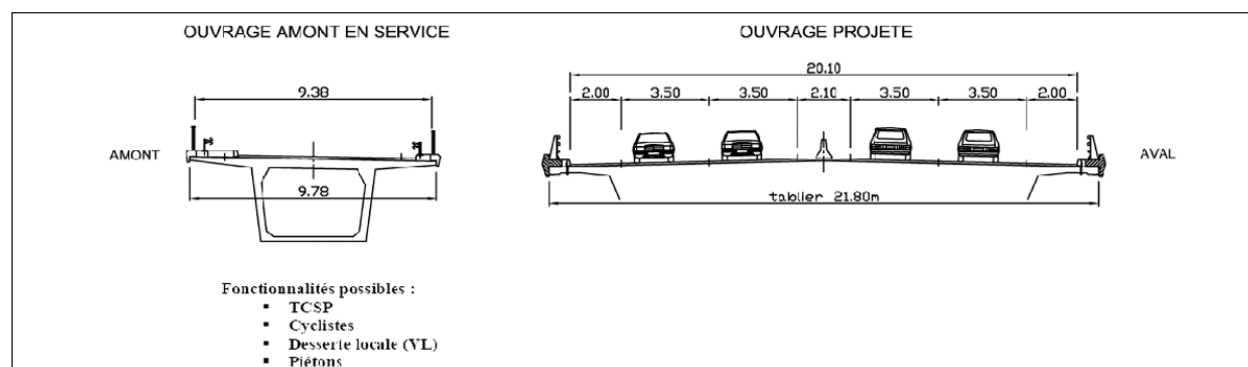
Profils en travers de l'ouvrage amont et de l'ouvrage à reconstruire
